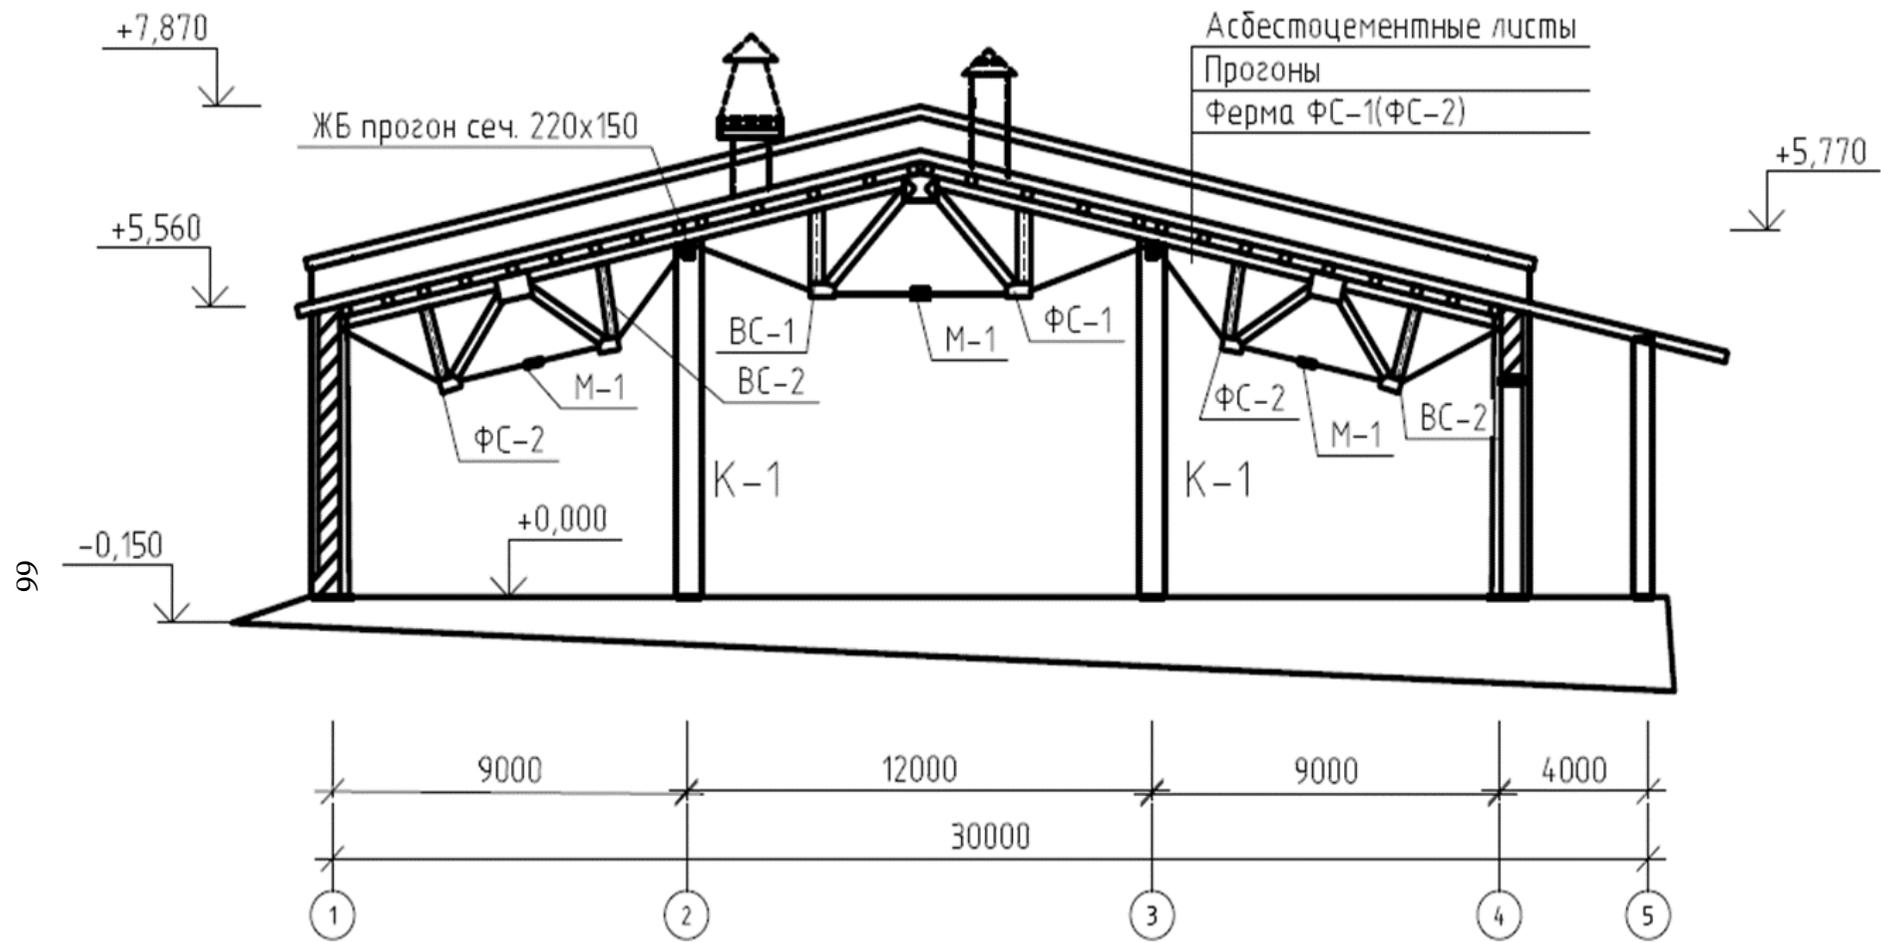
Поперечный разрез здания 1-1 по рис. 2.10
